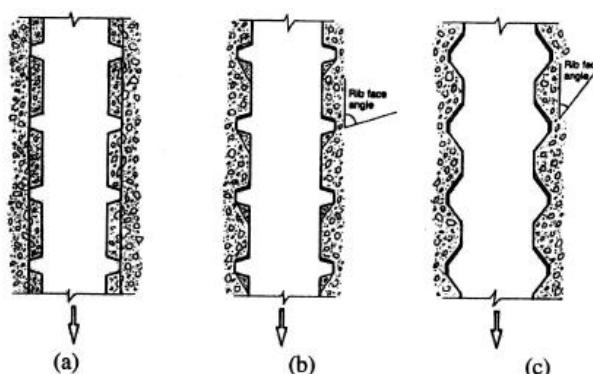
Disposição das nervuras transversais e longitudinais de uma barra de aço, segundo LNEC
